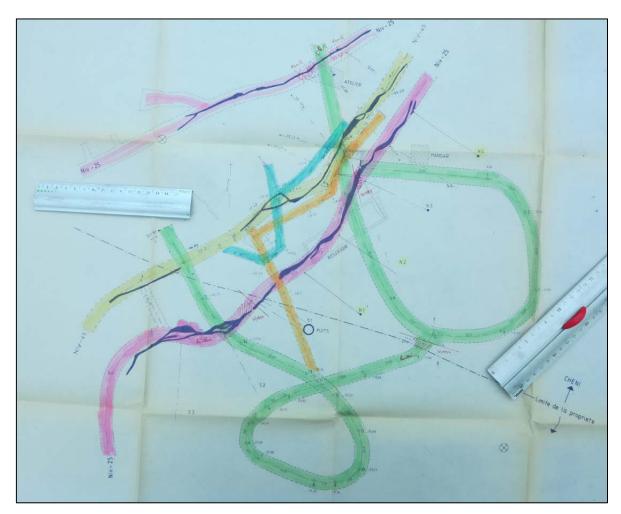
Plan des travaux miniers du secteur de Ty-Gardien, 1/200 (source : CHENI Ty-Gardien)
